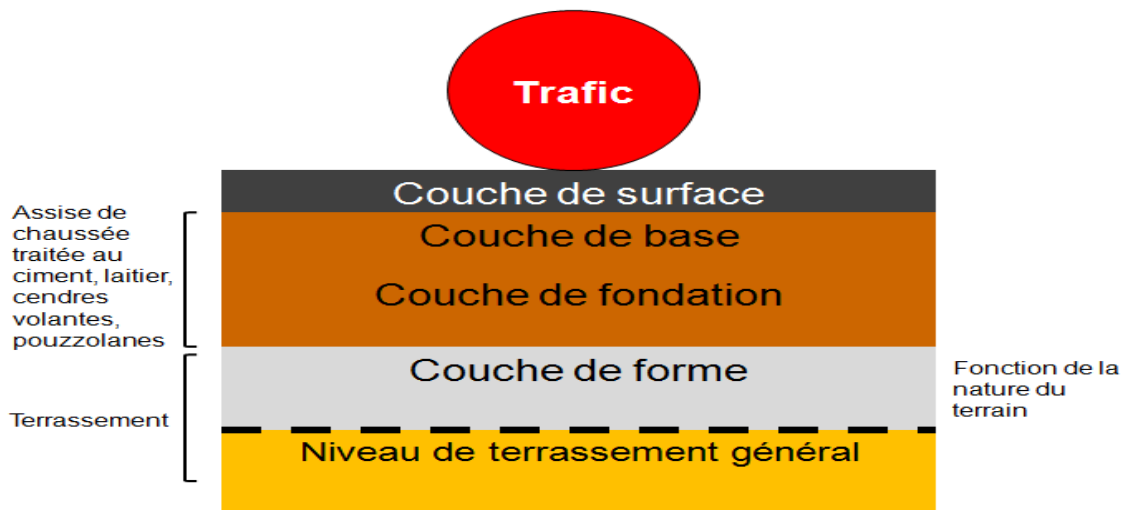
les couches d'une chaussée semi-rigides [2].
